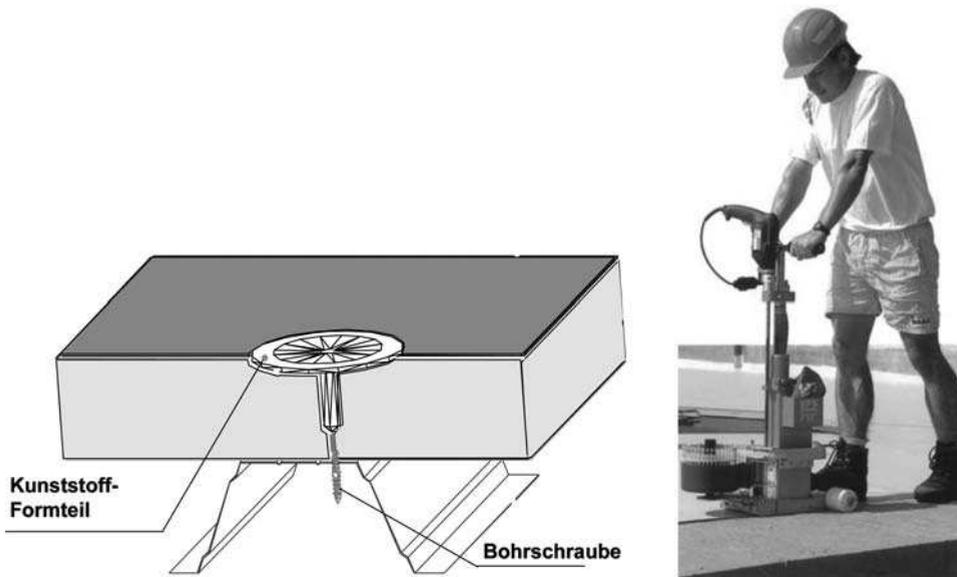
Mechanische Befestigung der Dachabdichtungsbahn auf der tragenden Dachunterschale
